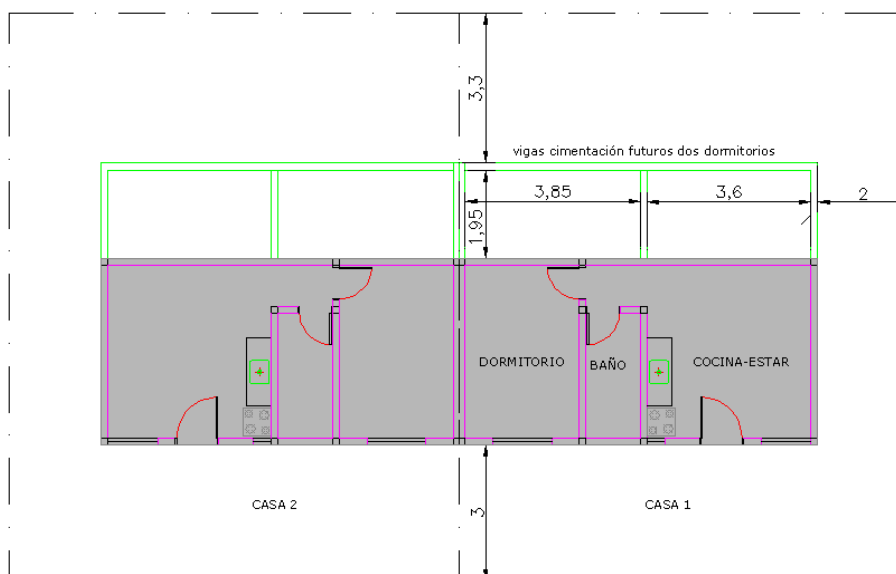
Planta tipo. Complejo de viviendas 19 de abril – Libertad – San José.
